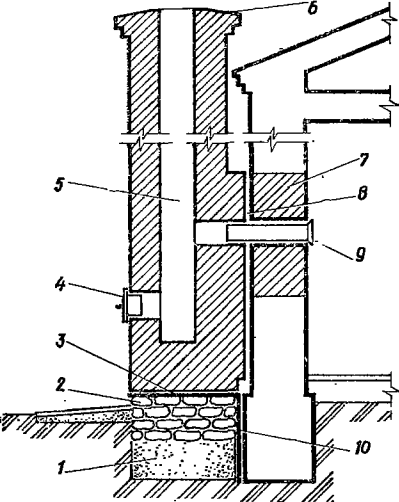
Кирпичная дымовая труба, пристроенная к наружной стене здания:
